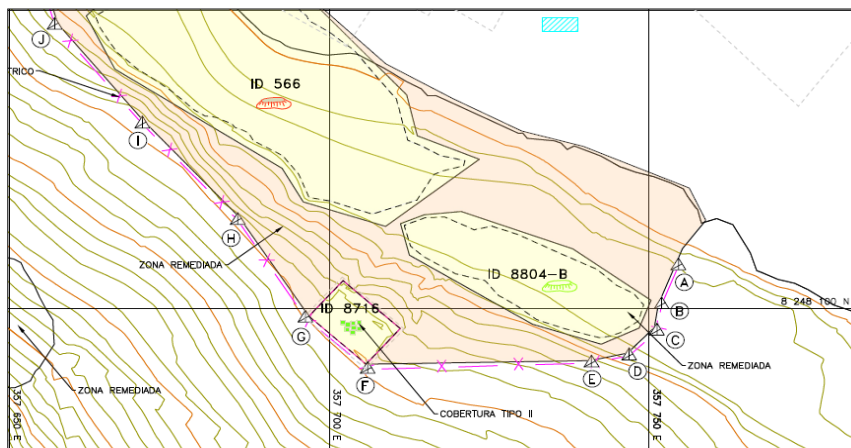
Vista en Planta desmonte de mina ID 8804-B
